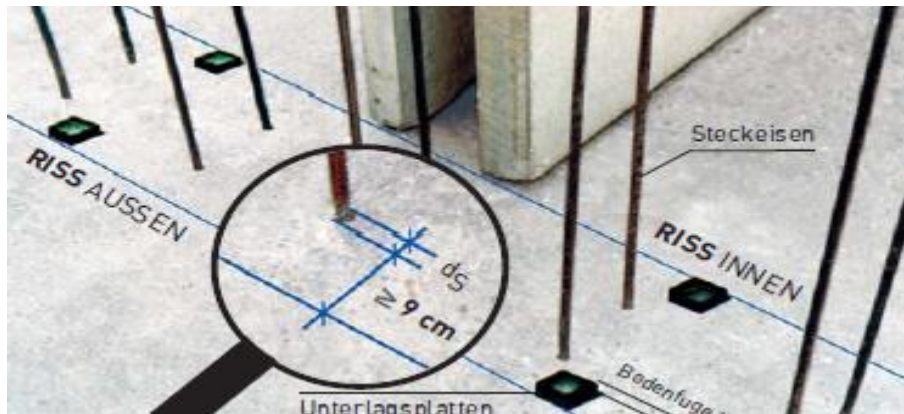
| Auflagerpunkte und Anschlussbewehrung¹²⁸
